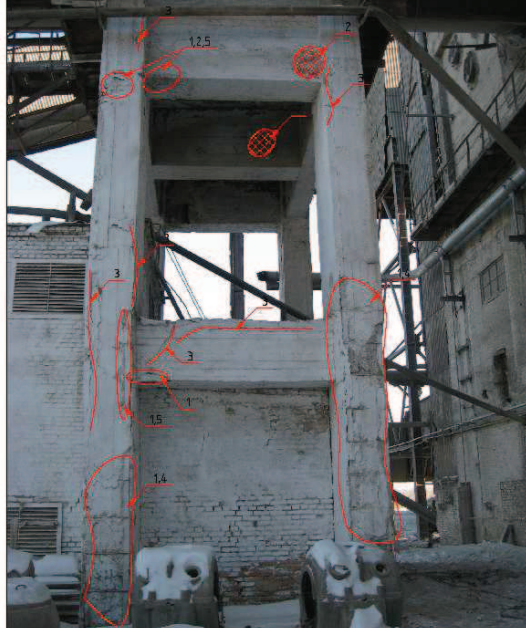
Дефекти і пошкодження опори П4/О7: 1- зруйнований бетон, 2-корозія та руйнування бетону, 3-тріщини, 4-оголена (корозія) арматури, 5-відшарування бетону
